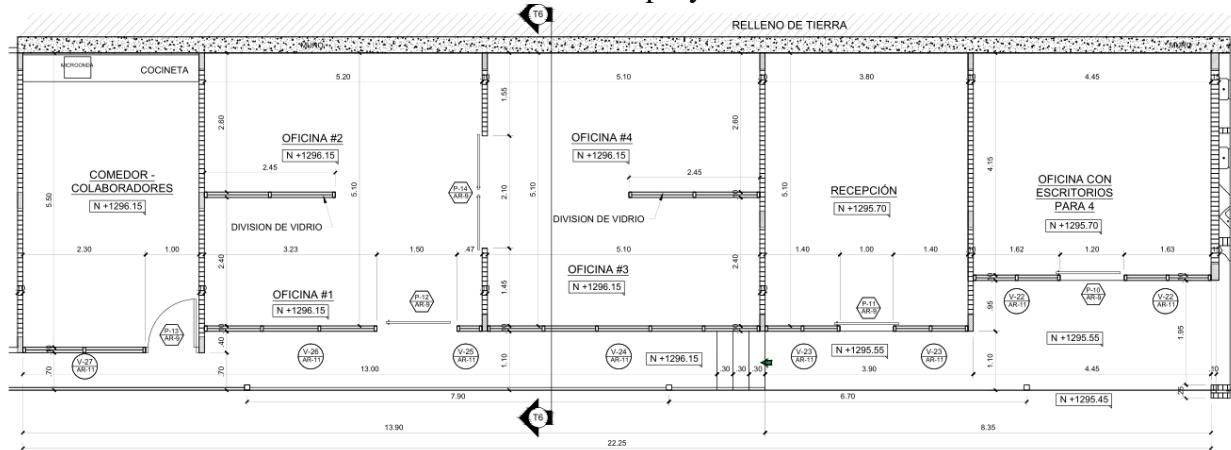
Planta arquitectónica (pabellón a remodelar para oficinas)
